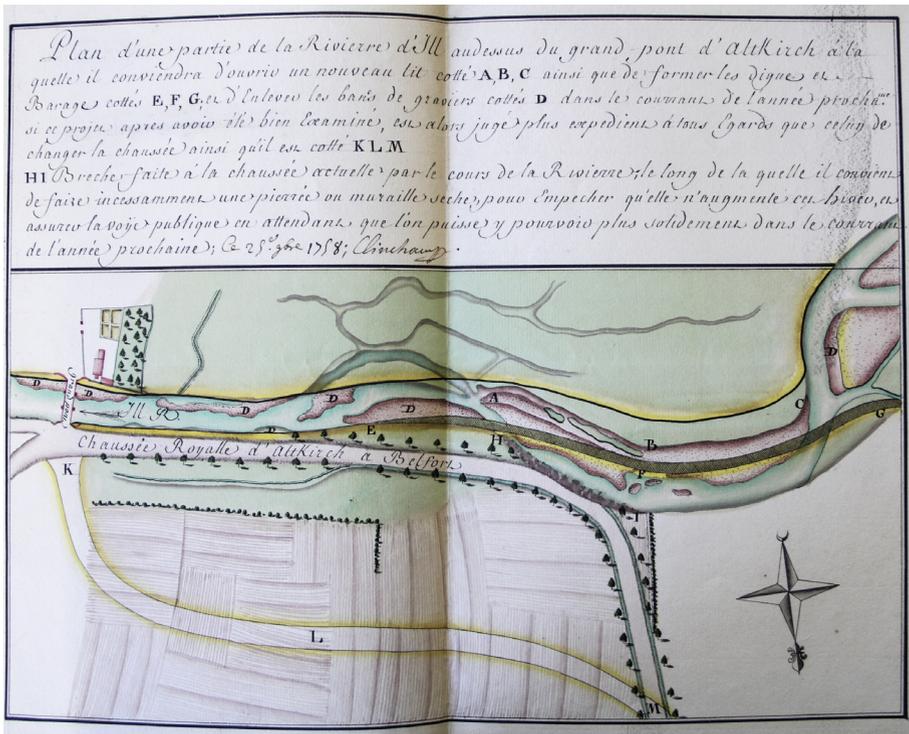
Plan de redressement de l'Ill à hauteur du pont d'Altkirch en 1758 (© ADHR, photo B. Furst).
